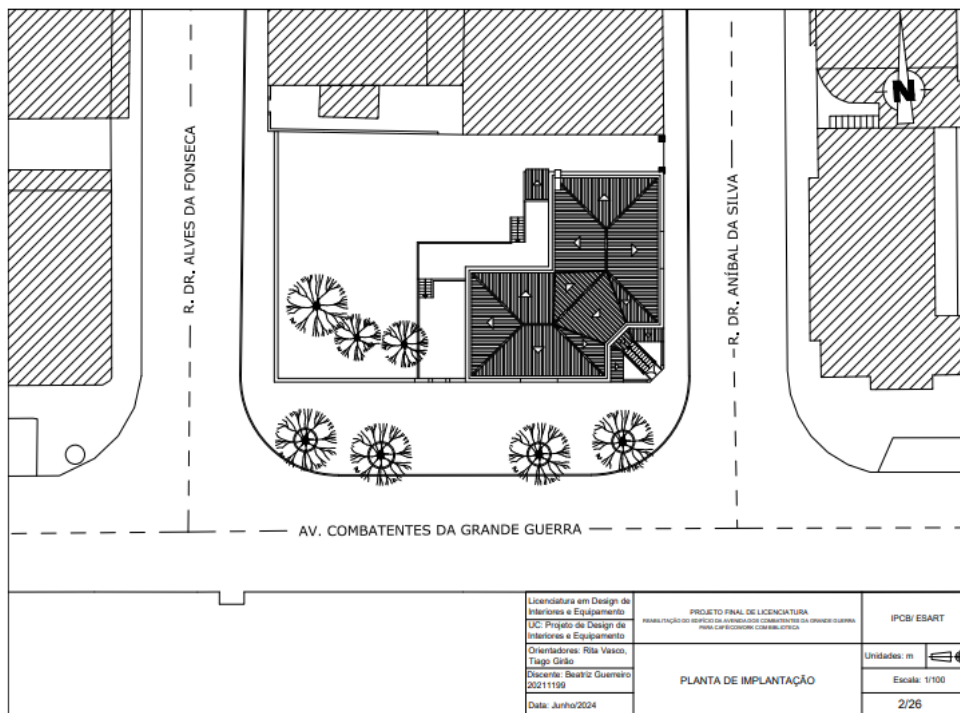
Planta de implantação, sem escala. Fonte: Autor
